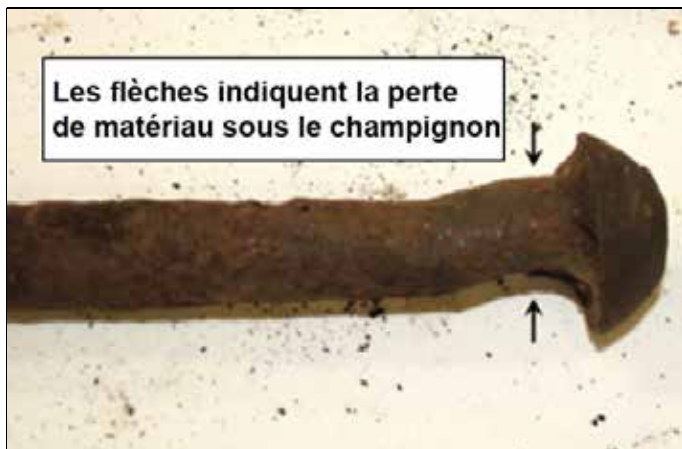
Crampon à section arrondie avec perte de matériau sous le champignon
